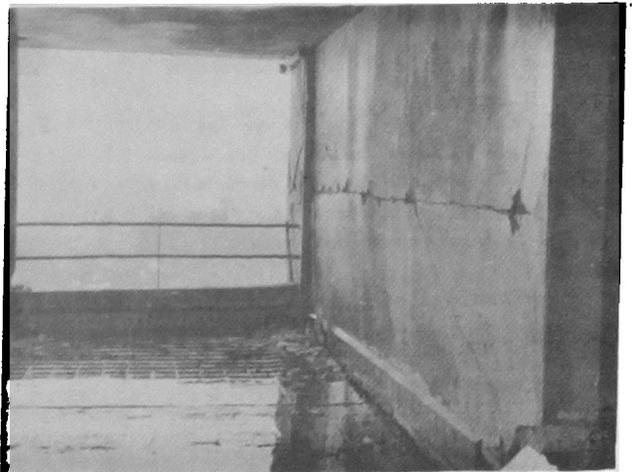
Junta de hormigonado en muro. Caja de escaleras. Hospital Regional de Valdivia.
